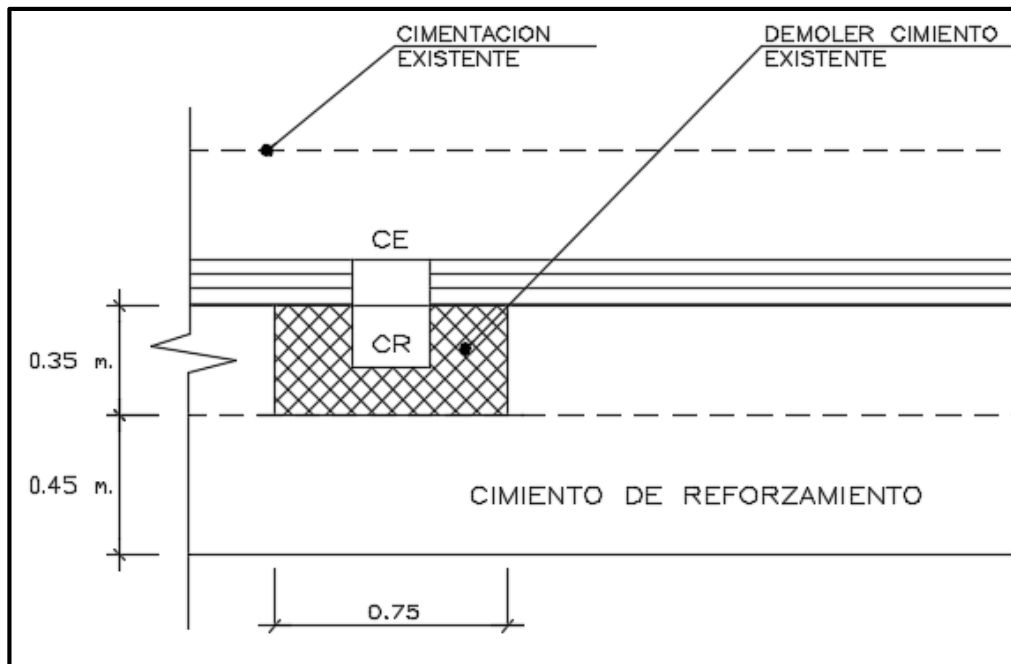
Procedimiento para reforzamiento de columnas - Planta
